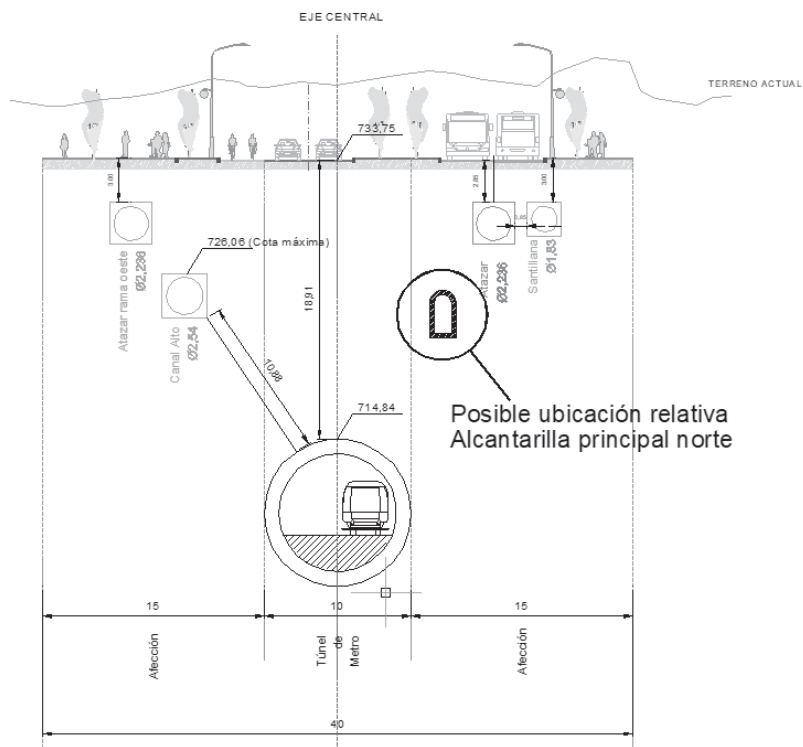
Sección donde se pone de manifiesto la necesidad de coordinar la ejecución de la alcantarilla principal con el resto de las infraestructuras
